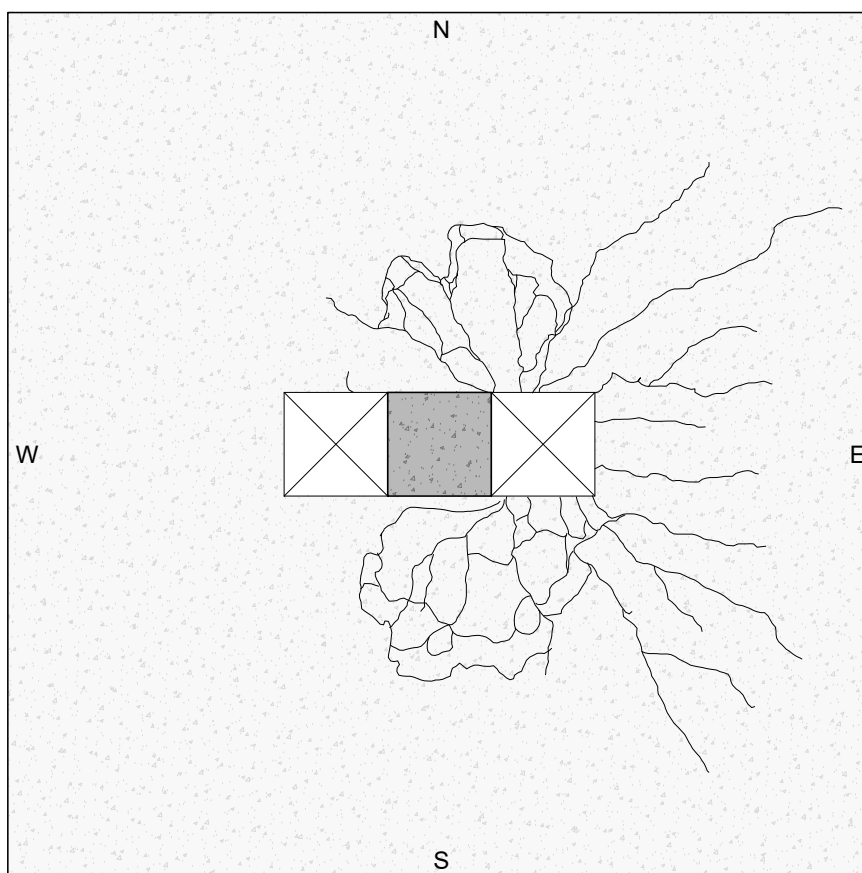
Padrão de fissuração da laje LFE1
